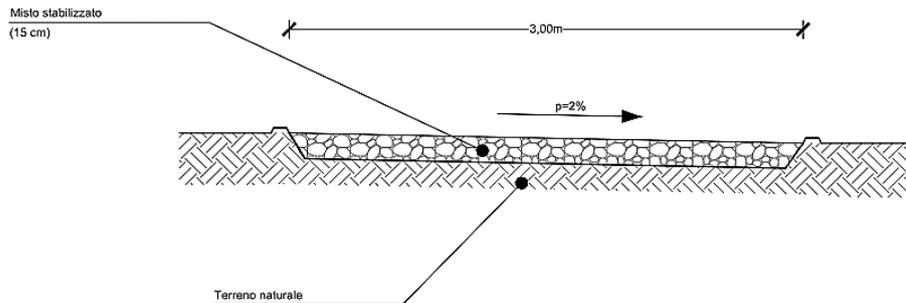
Sezione tipo strade interne al sito di progetto (Fonte: ns elaborazione)
